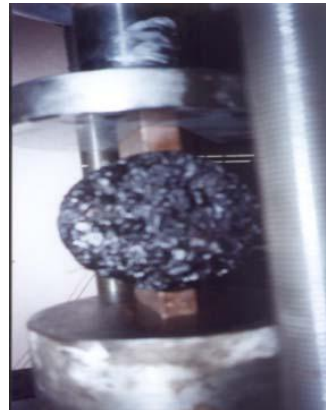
Forma en que se colocan las probetas en la Versa Tester para su ensaye a Tensión
